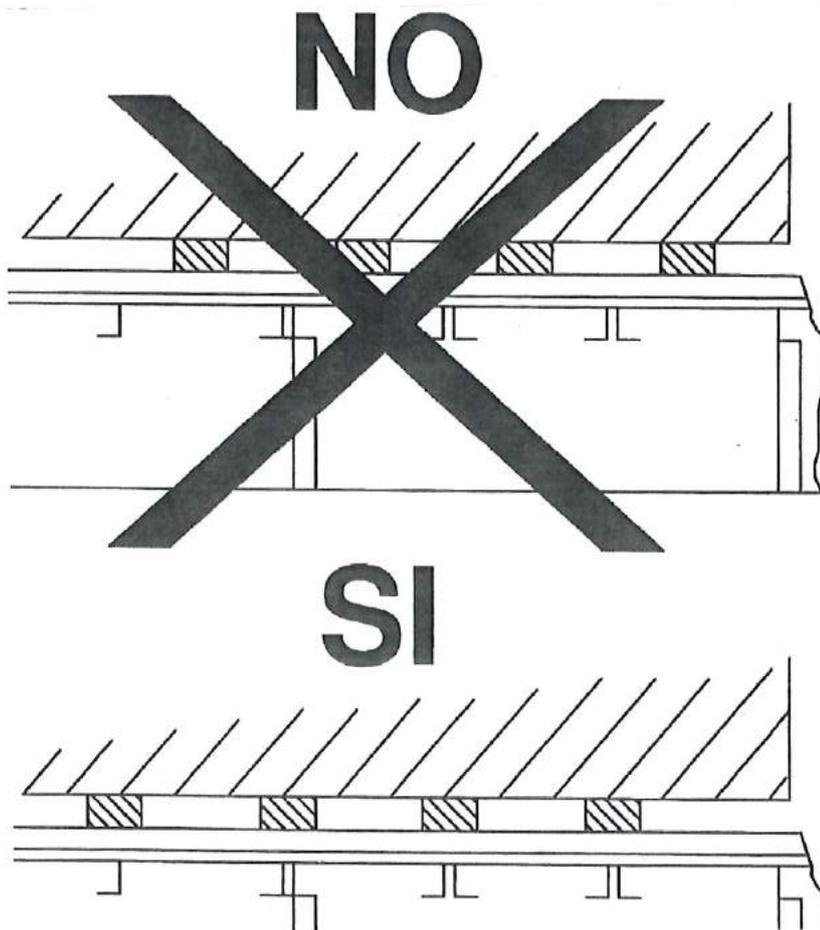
Colocación carga sobre maderas y viguetas
